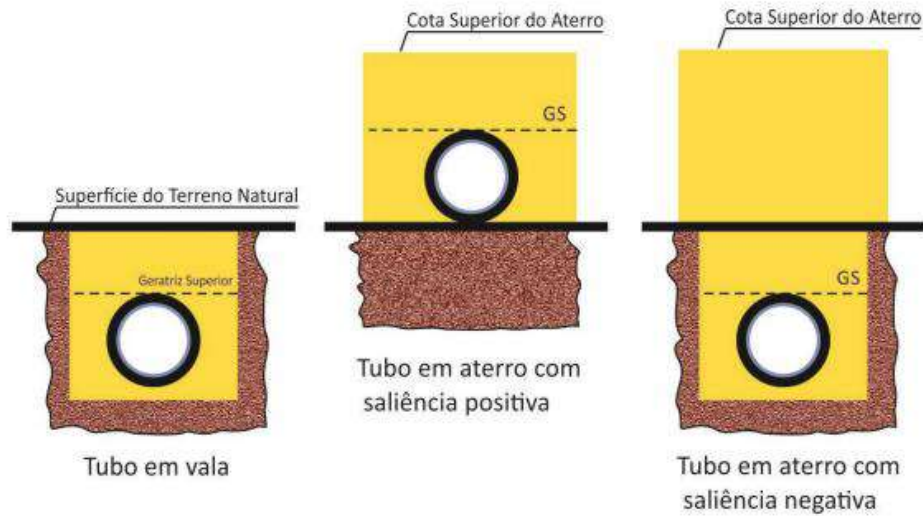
Condições de Instalação de tubos em vala ou aterro
